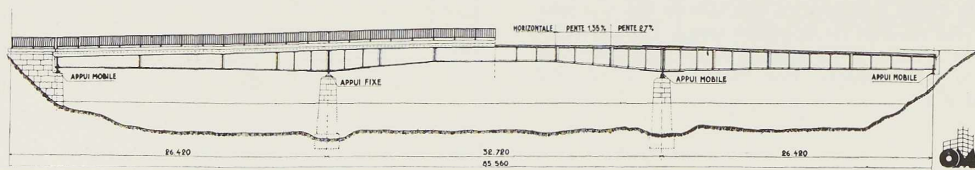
Vue et coupe longitudinale du pont sur la Thur.
